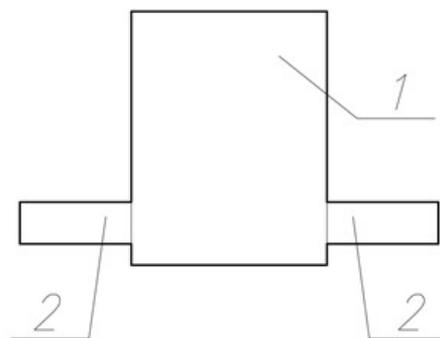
Приведенная площадь сечения армированного образца, где 1 – площадь деревянного бруса, 2 – площадь стеклопластиковой арматуры.
